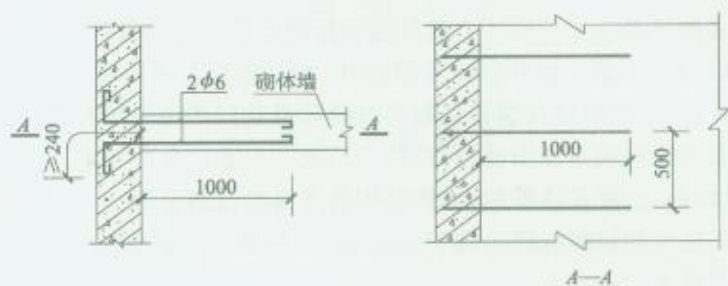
砌体墙与钢筋混凝土柱(墙)的拉结
